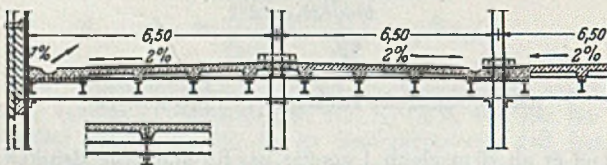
Stahlbetondecke mit verschieden hoher Aufstellung (ab 1920).
